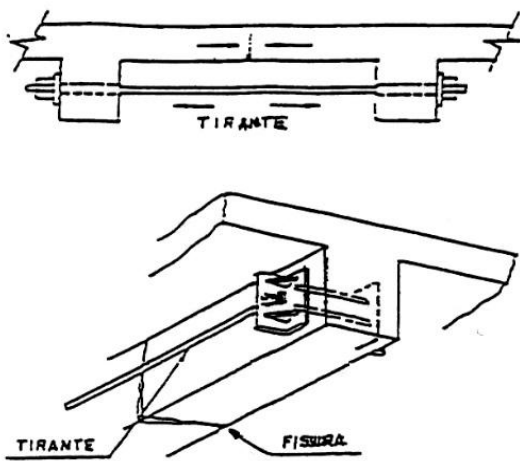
Pré-esforço no reforço de uma laje e de uma viga [2]
